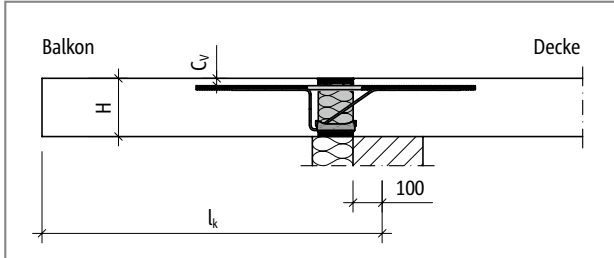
Schöck Isokorb® CXT Typ K: Statisches System
